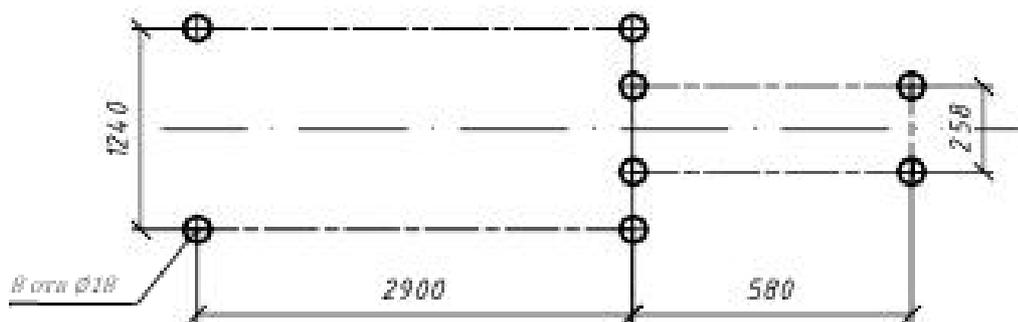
Схема размещения отверстий под фундаментные болты
